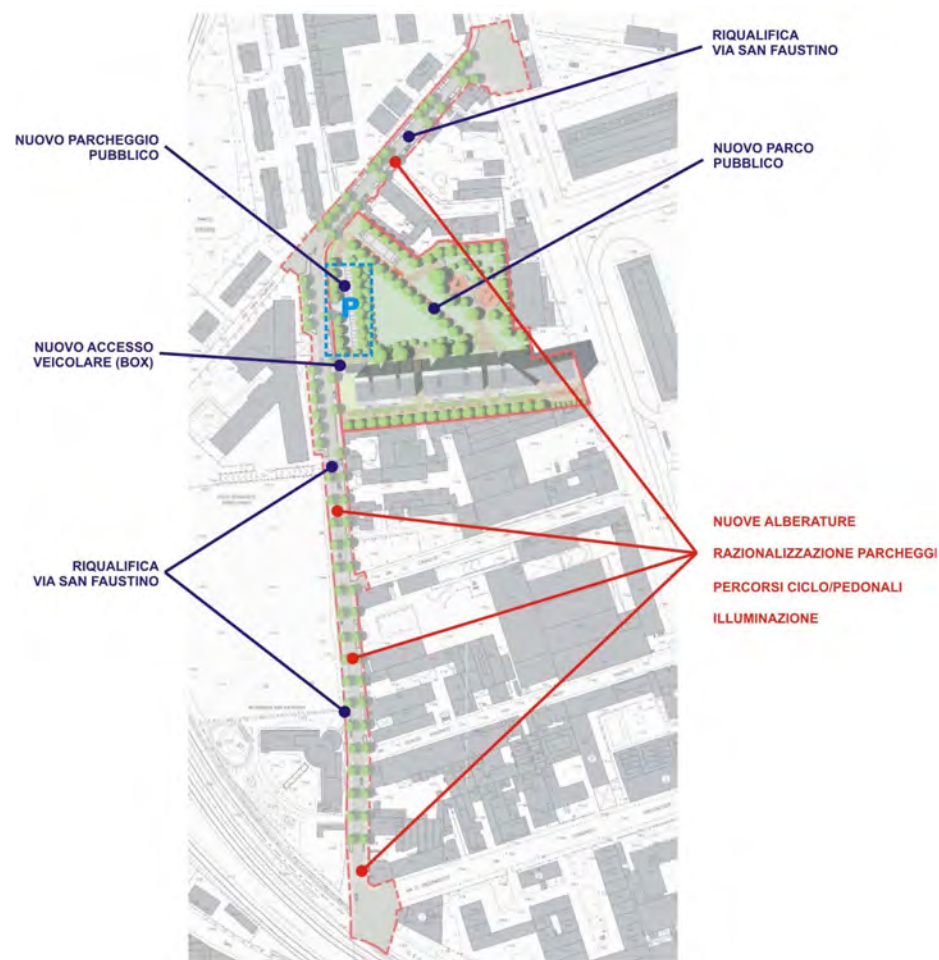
PII San Faustino – Planimetria di progetto – Interventi
